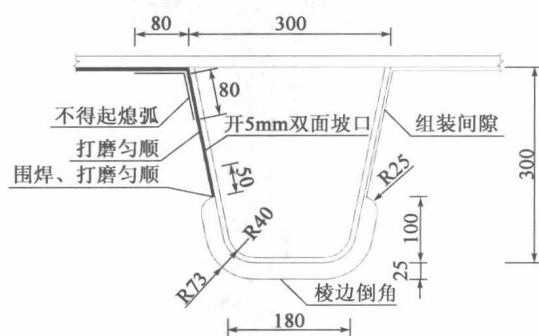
组装、焊接、细部处理要求(尺寸单位:mm)
